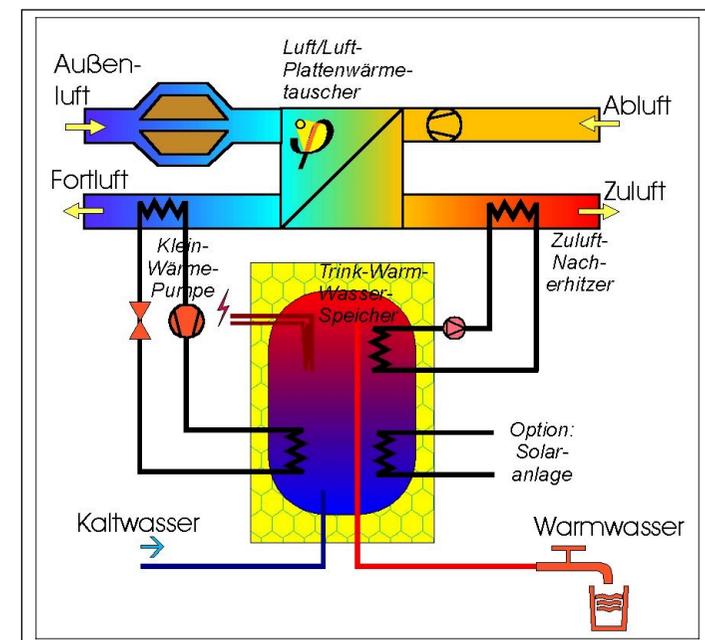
Wärmepumpenkompaktaggregat für Passivhäuser: Die gesamte Haustechnik für Heizung, Warmwasser und Lüftung in einem Kompaktgerät von Gefrierschrankgröße vereint
